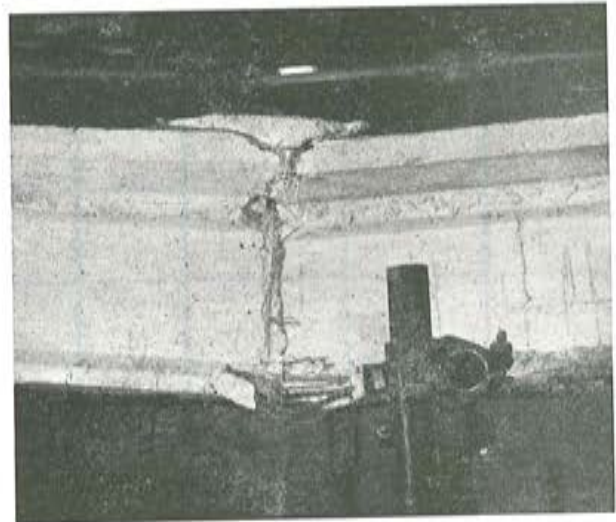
Fisuración y rotura viga testigo número 2.
